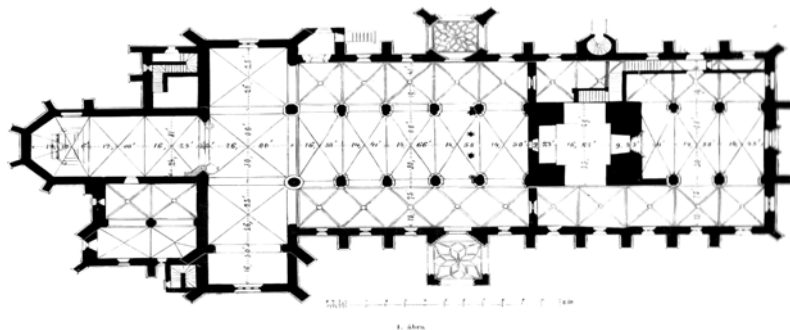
Grundriss der Marienkirche in Hermannstadt
